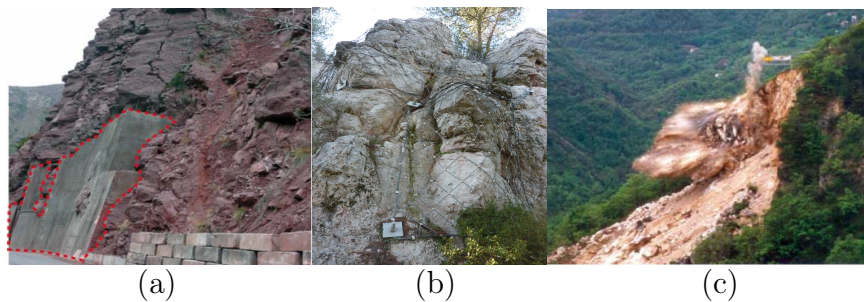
Exemples de parades actives : (a) Mur de soutènement (source : BRGM) ; (b) Filet plaqué (source : GIA Ingénierie) ; (c) Reprofilage (source : BRGM)
